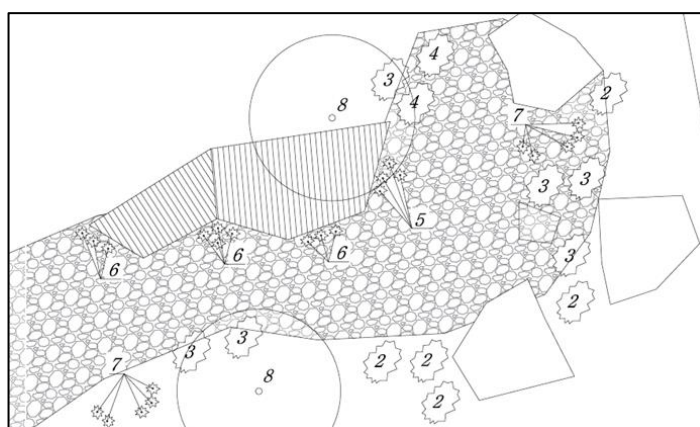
Фрагмент генплана 8, схема посадки растений для зоны «сухого ручья»
